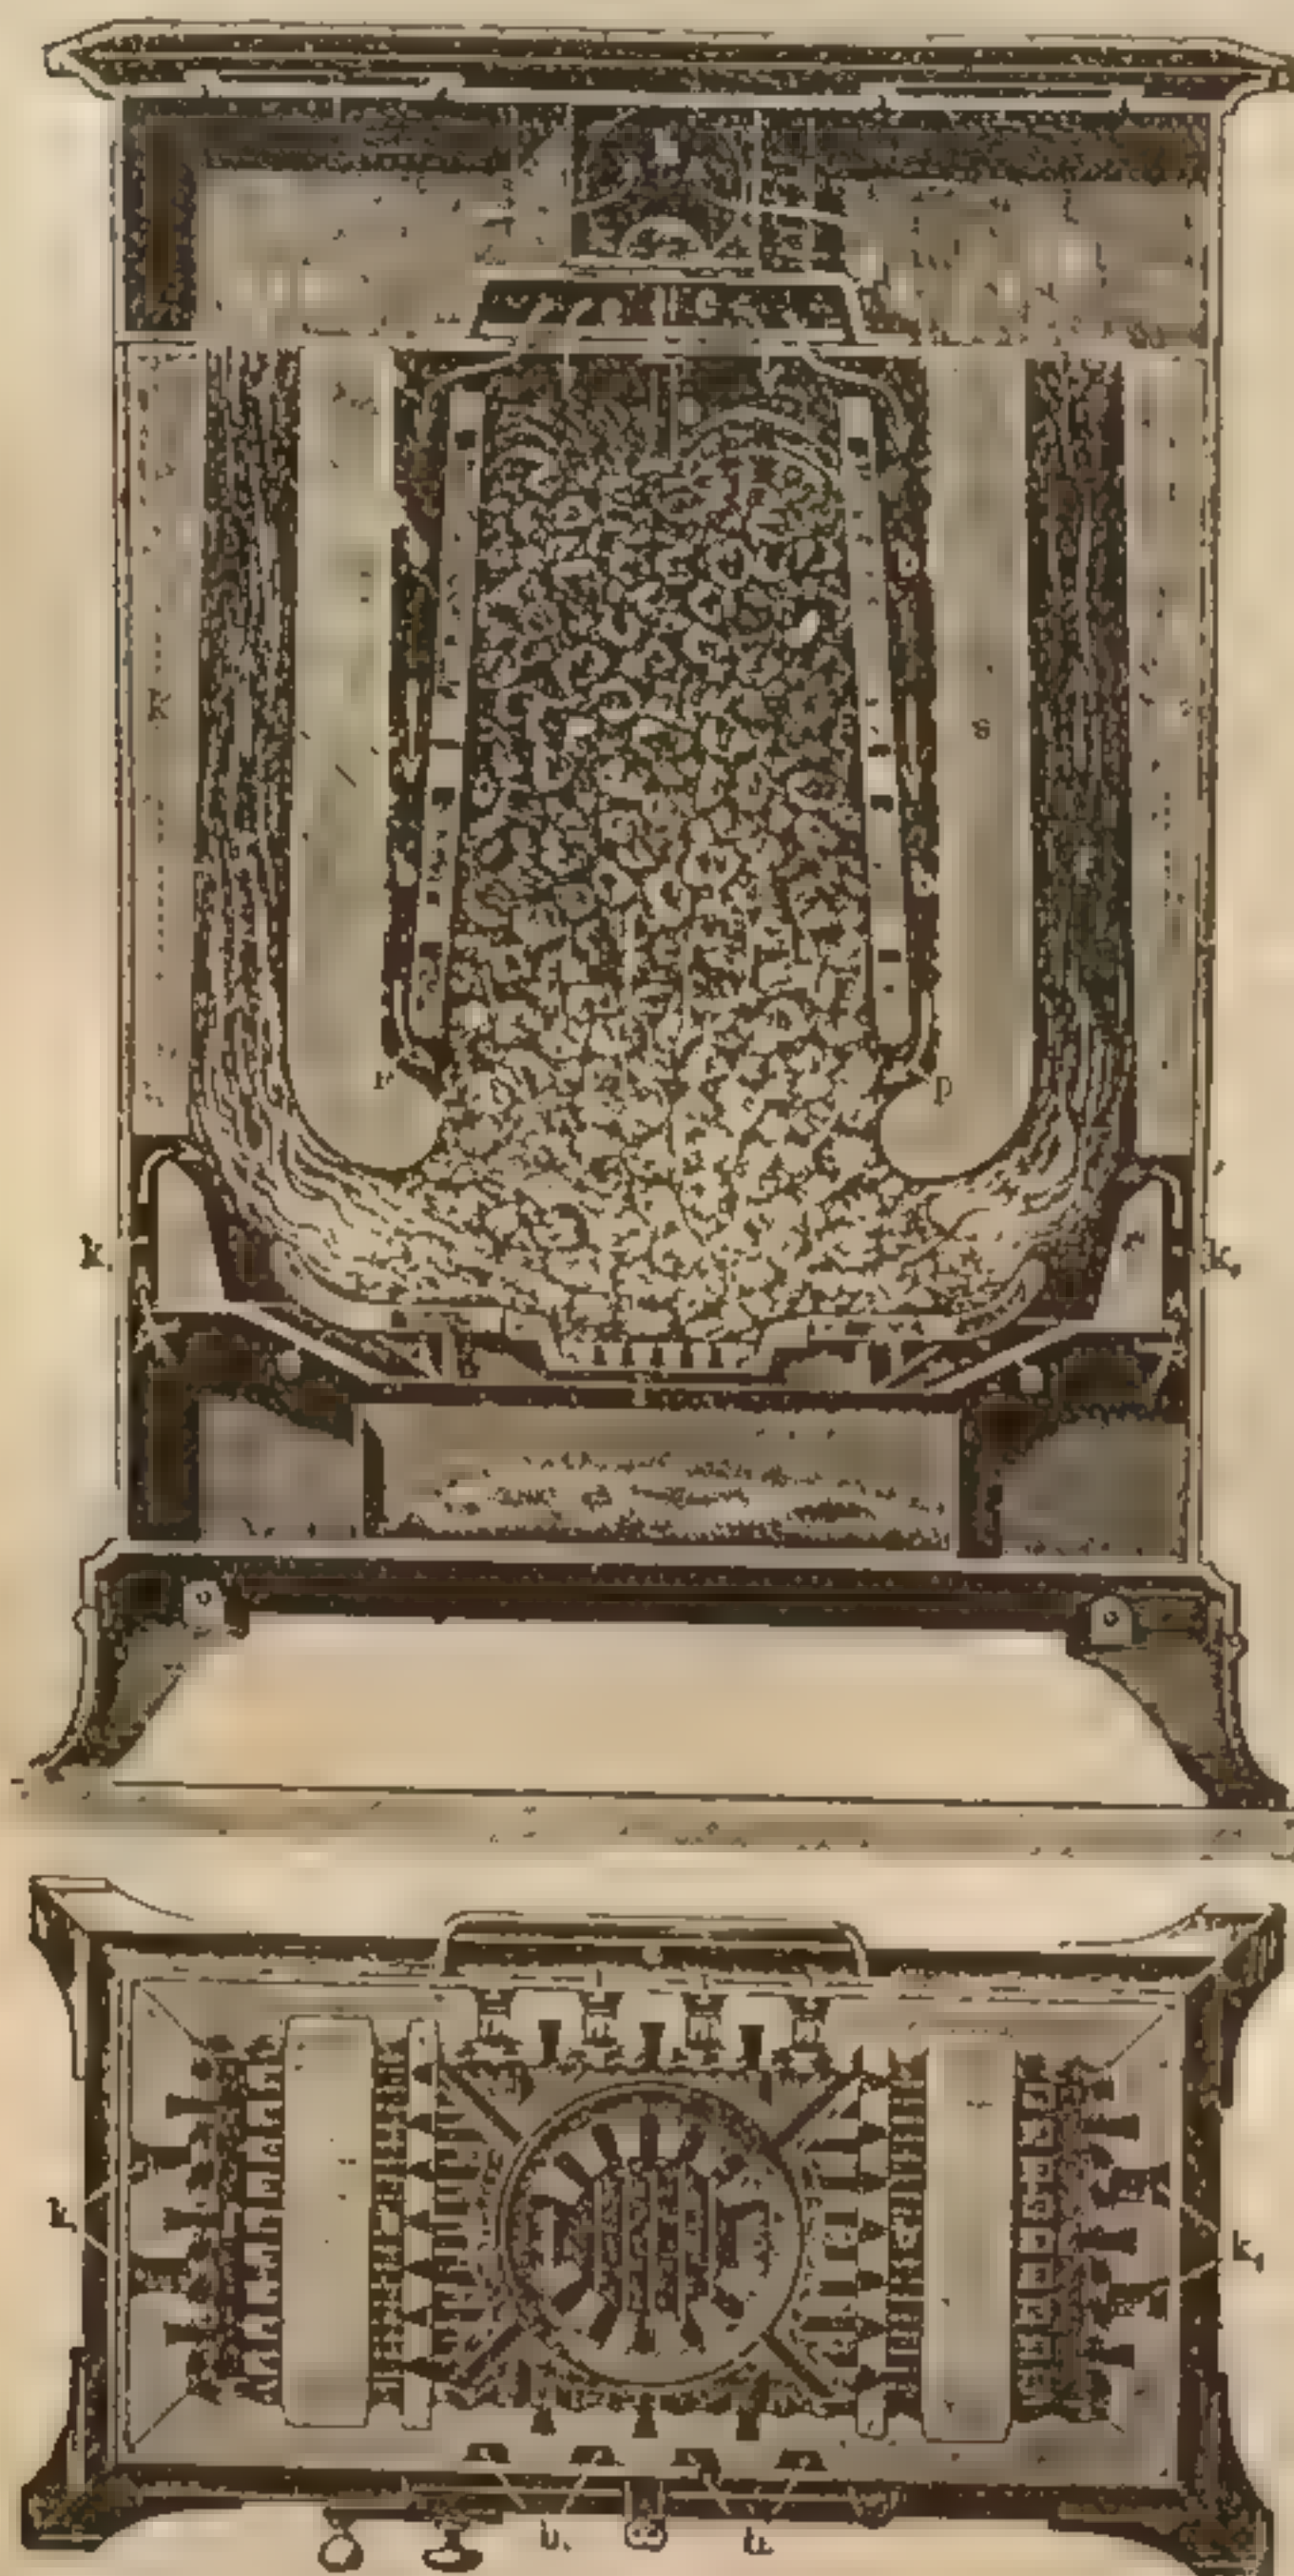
Школьная печь съ бездымнымъ сгораніемъ O. Winter'a (Ганноверъ). а—шахта для топлива; с—каналъ для притока воздуха, закрывающійся заслоночнымъ приспособленіемъ d и задвижной заслонкой e; b—каналы, отводящіе воздухъ и образовавшіеся изъ горючаго матеріала газы черезъ щель g въ отверстія P и въ пламя; f—каналы дымовыхъ газовъ, попадающихъ черезъ h въ дымовую трубу; i—рѣшетка; K₁—каналы для вторичнаго воздуха для достиженія полного сгорания дыма; l—отверстія и m каналы для воздуха, притекающаго подъ рѣшетку; s и k—камеры изъ огнеупорнаго кирпича, съ рѣзко выраженными желобками, способствующія при притокѣ воздуха свободному прониканію воздуха и перенесенію процесса сгорания къ стѣнкѣ печи, а при отведеніи дымовыхъ газовъ лучшей отдачѣ тепла благодаря большей поверхности; o—перегородки изъ жести, ведущія воздухъ къ K₁.
